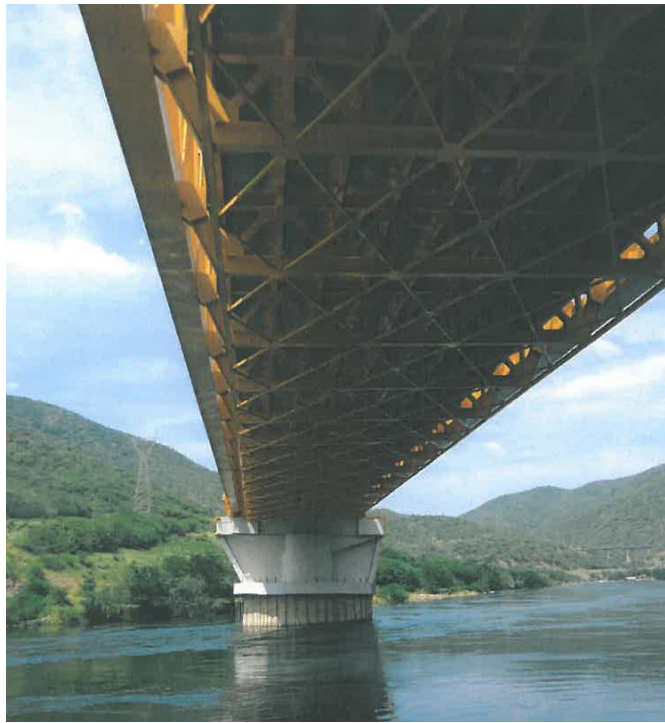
Vista de la pila inclinada desde el Estribo 1.
